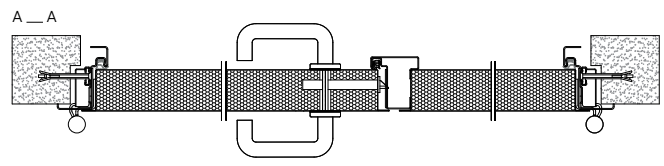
Horizontalschnitt zweiflügeliger Stahl-Massivtüren mit Deckschicht ECO, mit Eckzarge auf der Schlosshöhe
